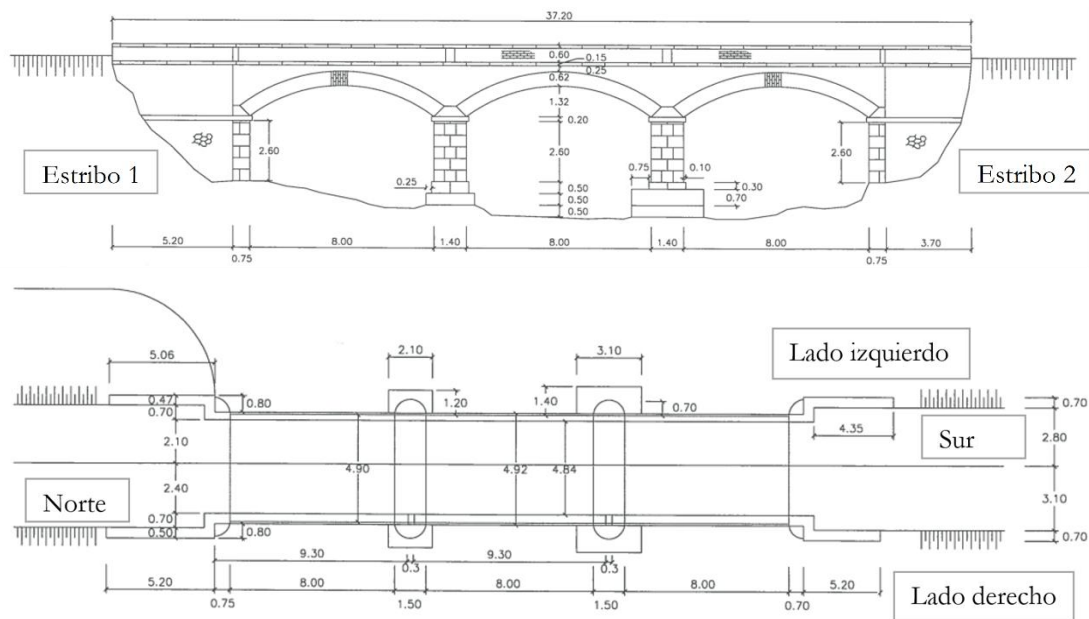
Alzado aguas abajo y planta del pontón de Villamanta (geometría anterior a las obras del 2003)
